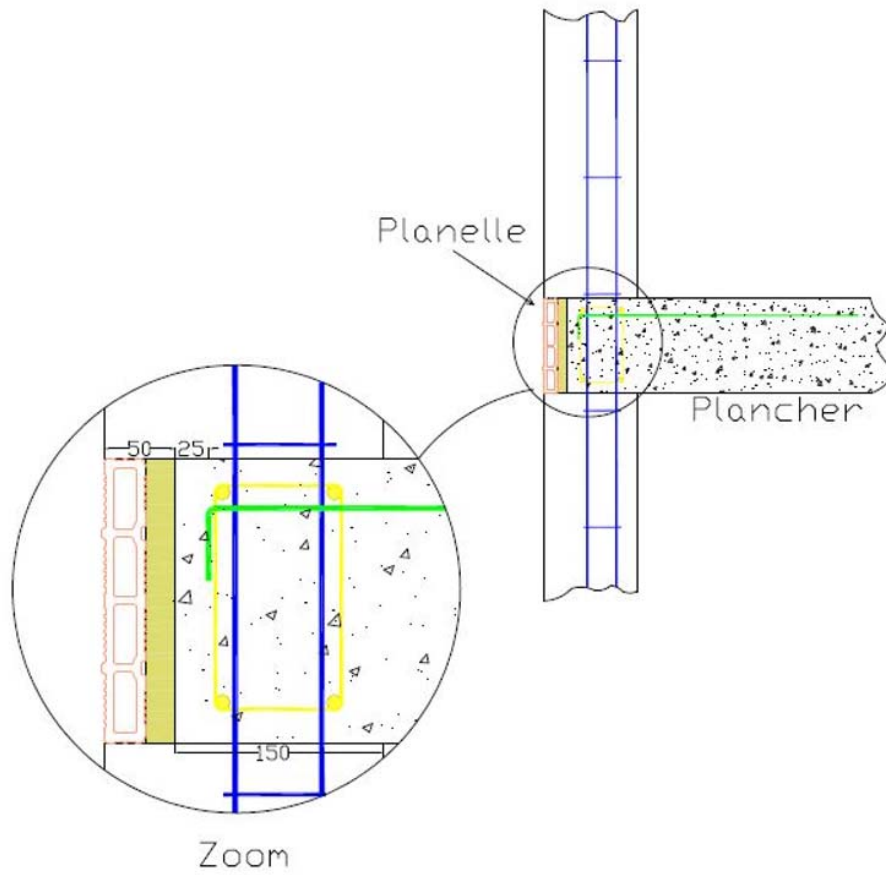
Passage des aciers, coupe verticale – Planelle ISO+
